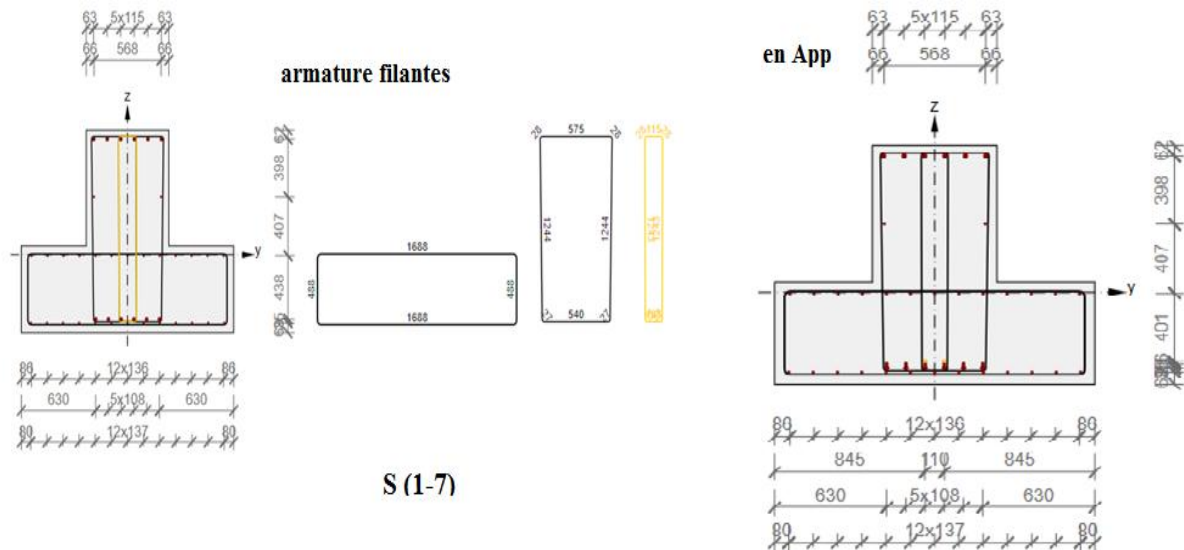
La coupe transversal des semelles (1 et 7).
